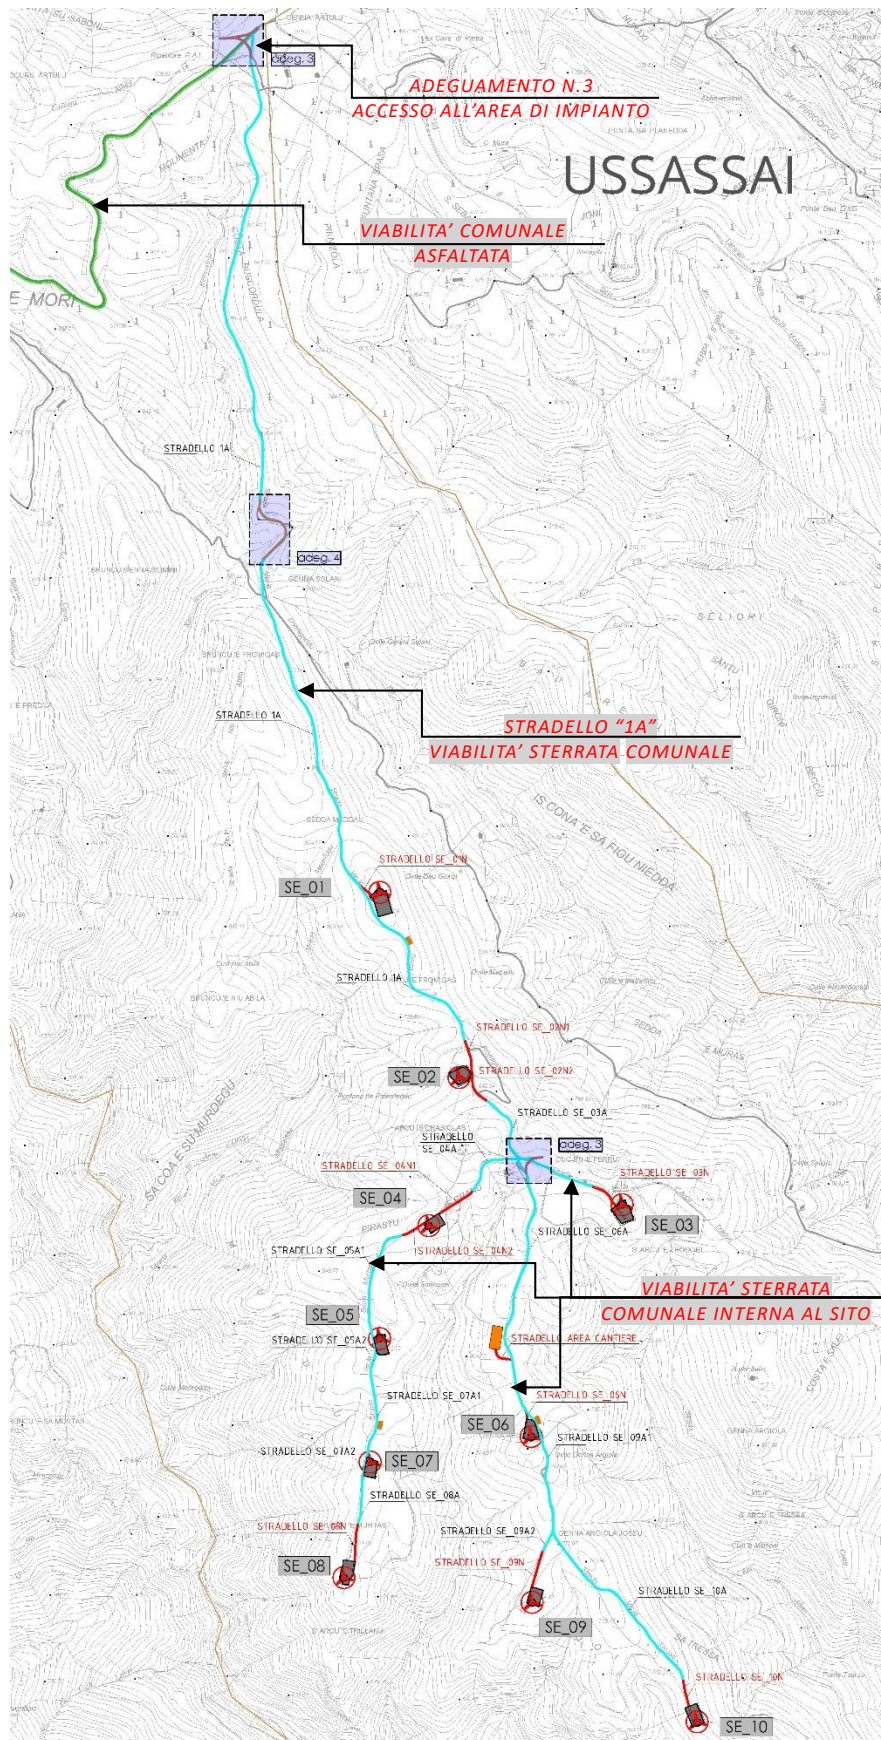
TRACCIATO STRADALE DALL'ADEGUAMENTO 3" ALL'AREA PRODUTTIVA E ALLE PIAZZOLE
